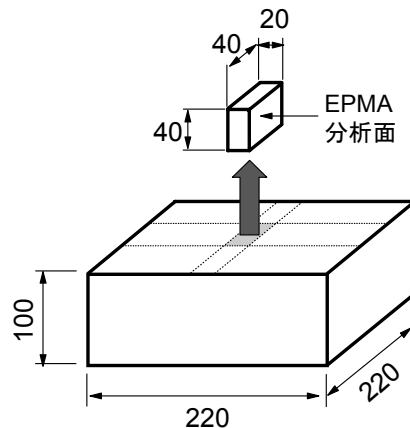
EPMA 試料採取位置 (単位 : mm)
